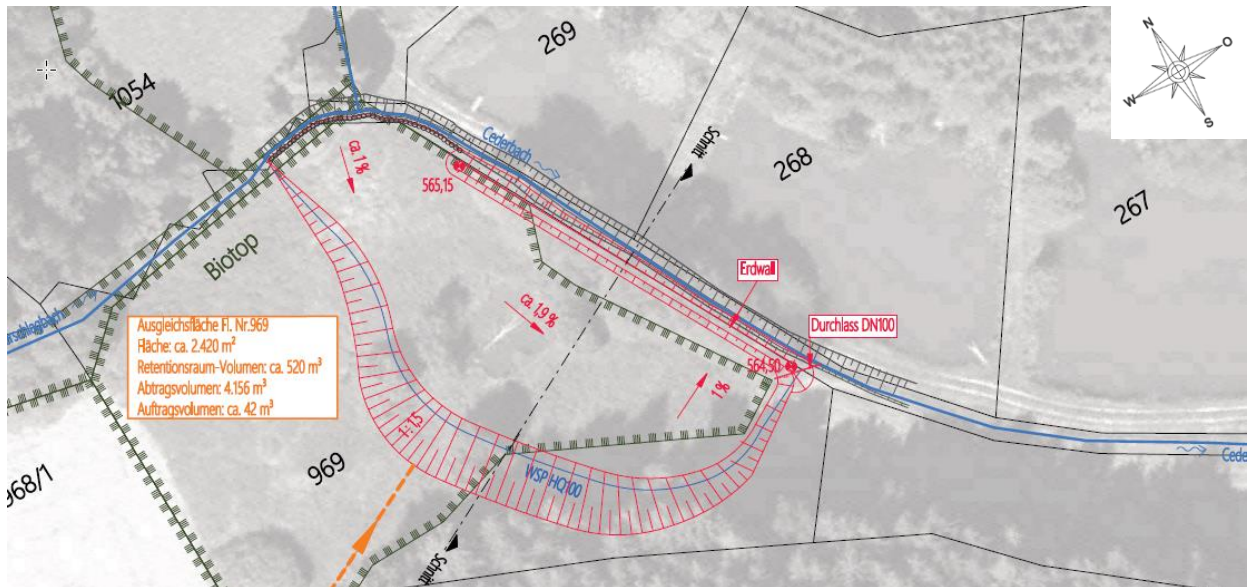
Planauszug – Lageplan Varianten gepl. Retentionsflächen (FI.Nr. 969).
